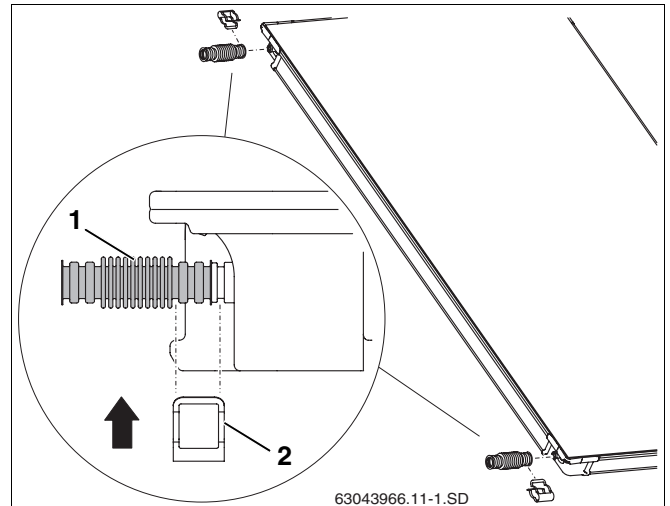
Montaje de la unión de tubo ondulado al primer colector
